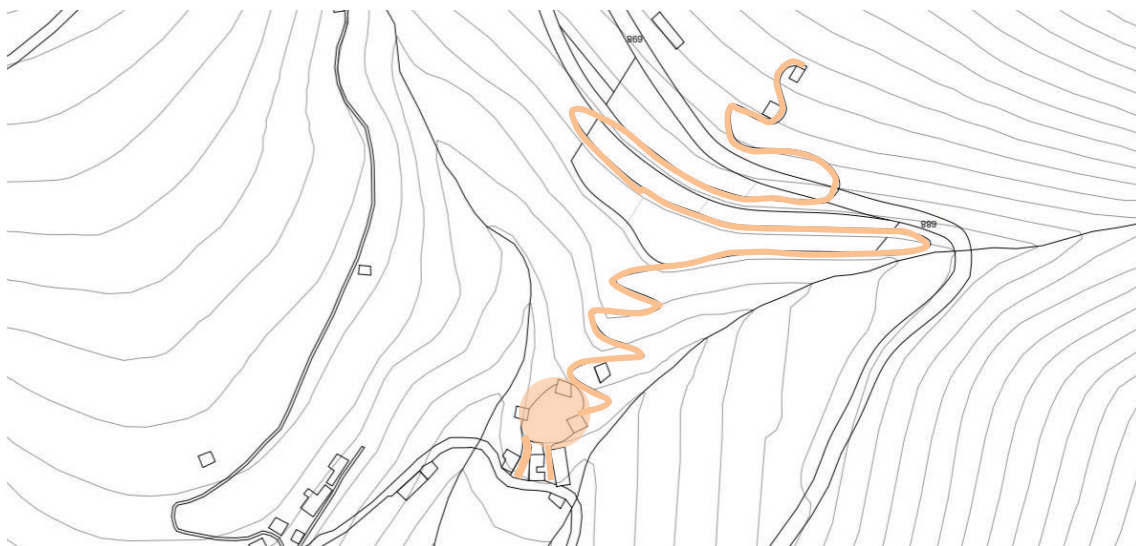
Planta com plano urbano desenhado a laranja (Imagem de autora Agosto de 2019)
